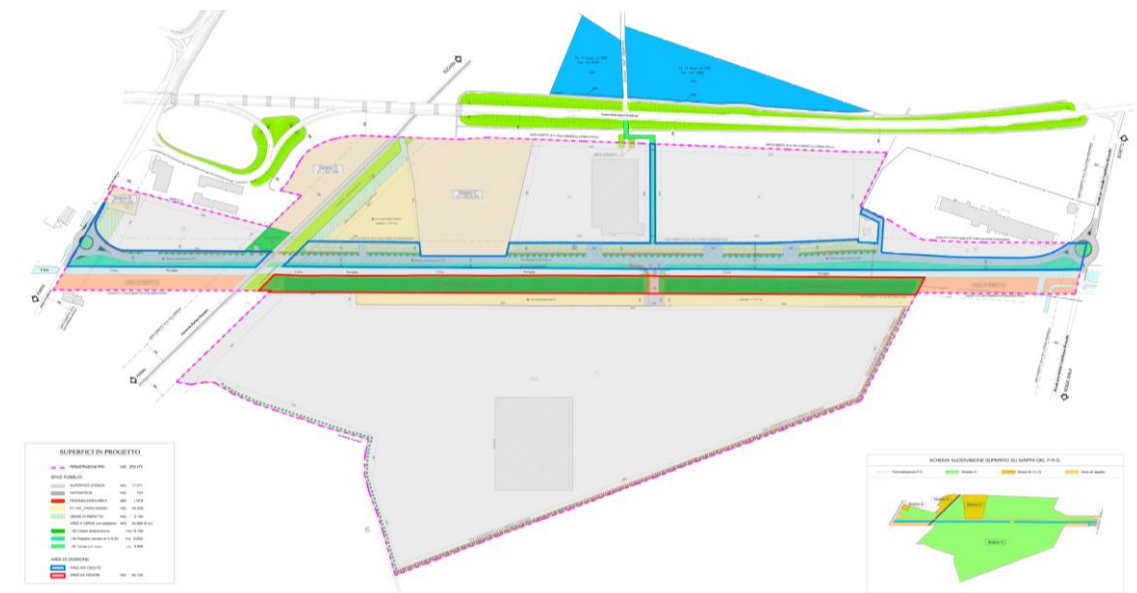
Tavola 8 – Planimetria di progetto – PPIP Dugara
